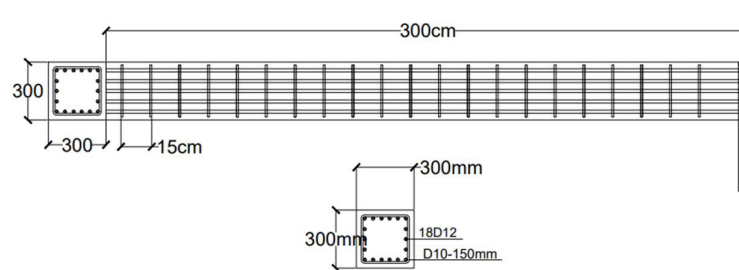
Detail Penulangan Balok (a) dan Kolom (b) Precast
